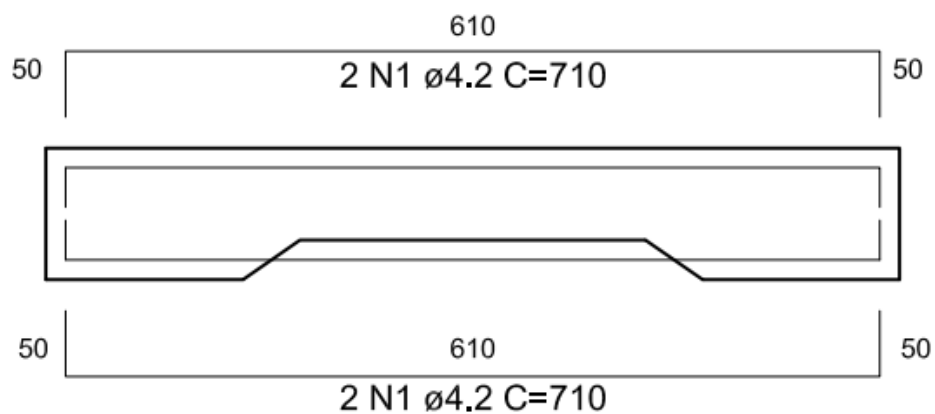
Detalhamento da armadura 1: barras de aço longitudinais (dimensões em mm).
